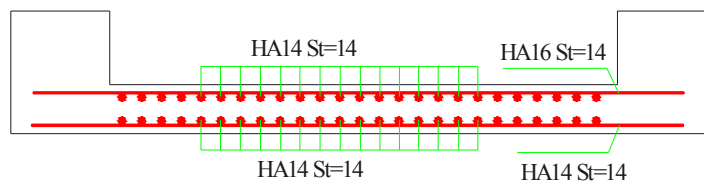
schéma de ferrailage du radier (coupe 1-1)
